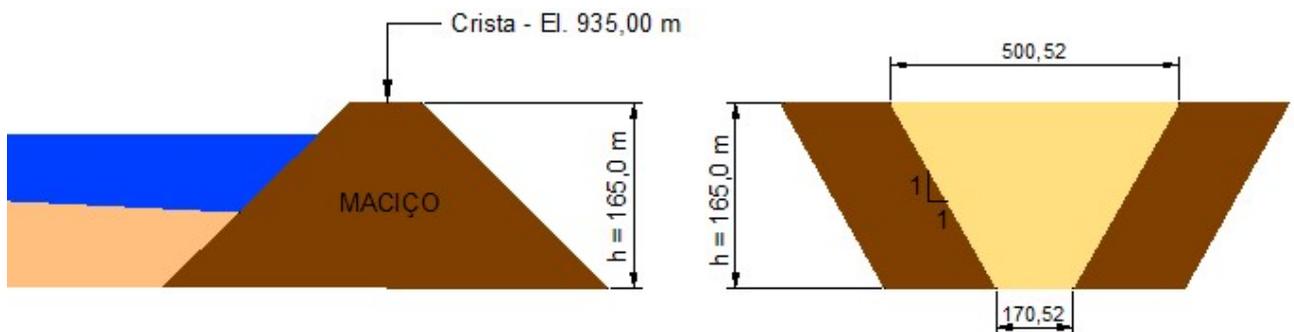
Croqui da brecha – Barragem 1 – Cenário final
